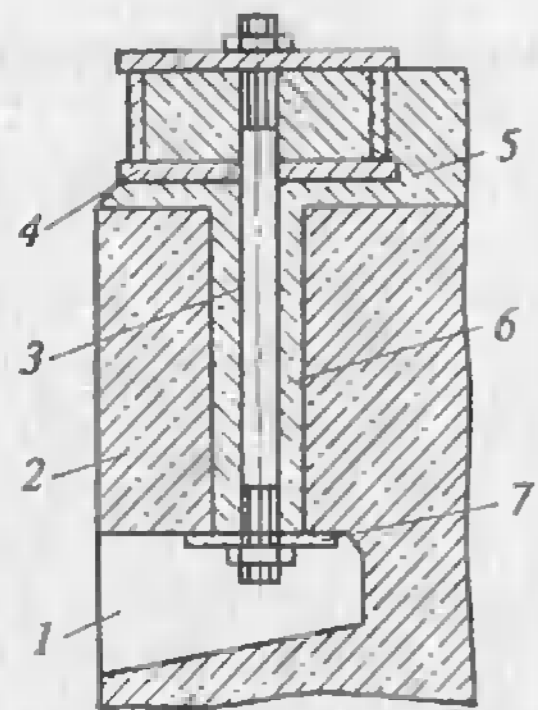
Колодец в фундаменте для установки фундаментных болтов: 1 — ниша; 2 — фундамент; 3 — фундаментный болт; 4 — фундаментная плита; 5 — цементная подливка; 6 — колодец; 7 — анкерная плитка
